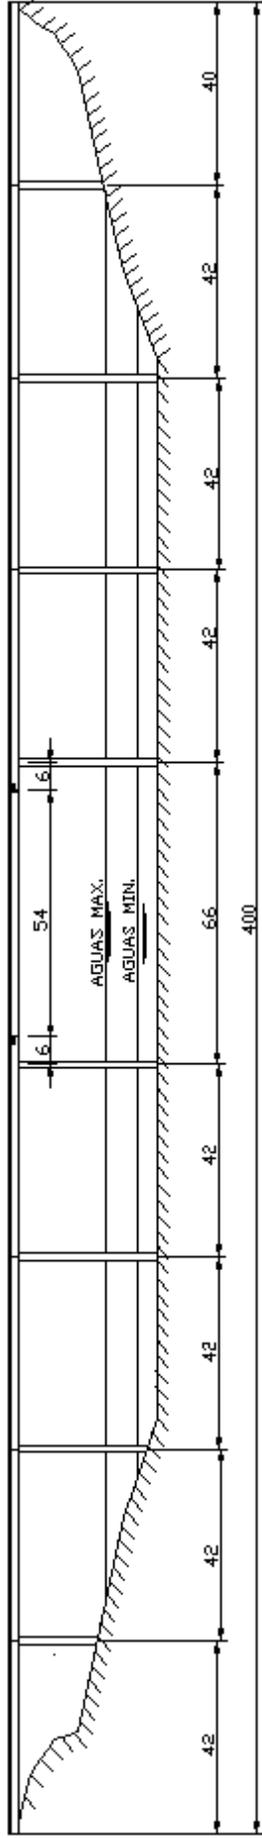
Opción n°4: Puente viga continuo. Sección Transversal.
